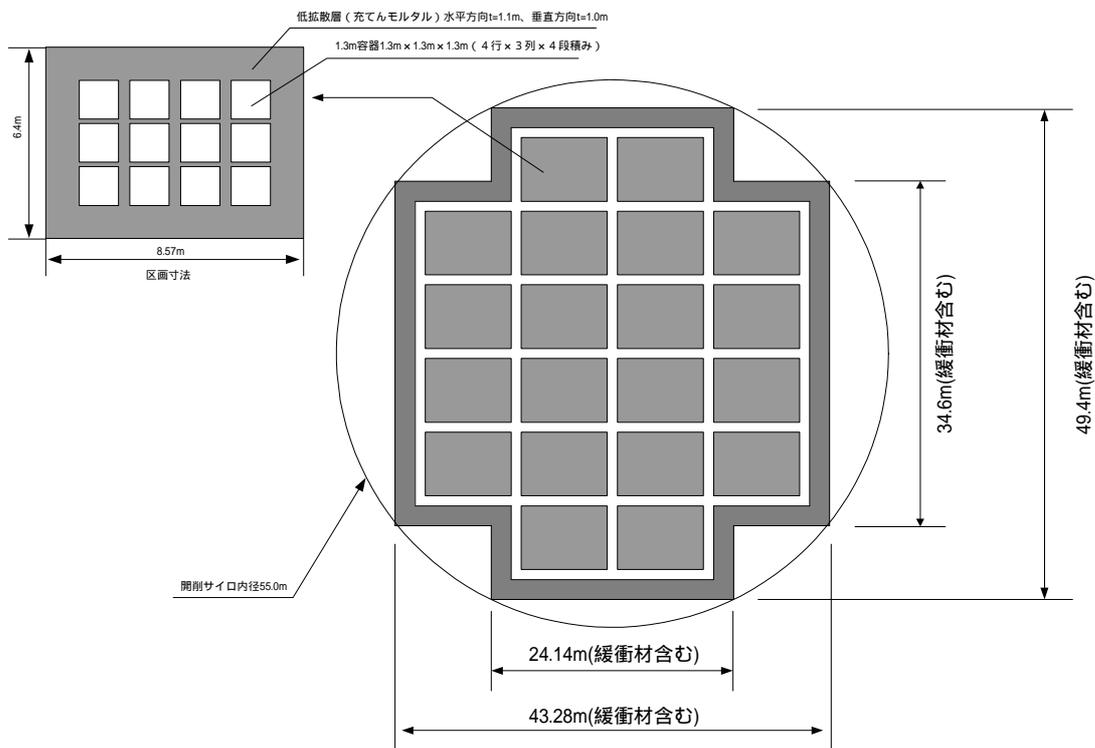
処分施設の平面図（開削サイロ型施設）
